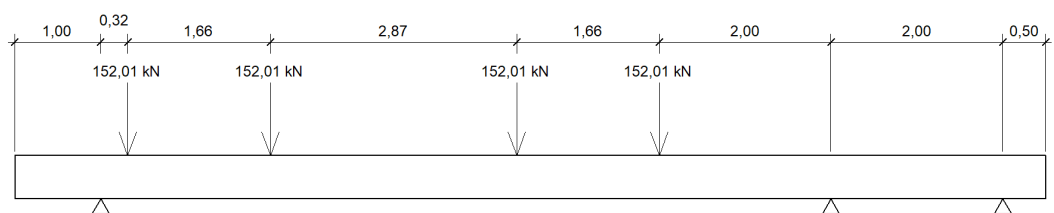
Esquema de cálculo en la situación más desfavorable para las vigas de maniobra
